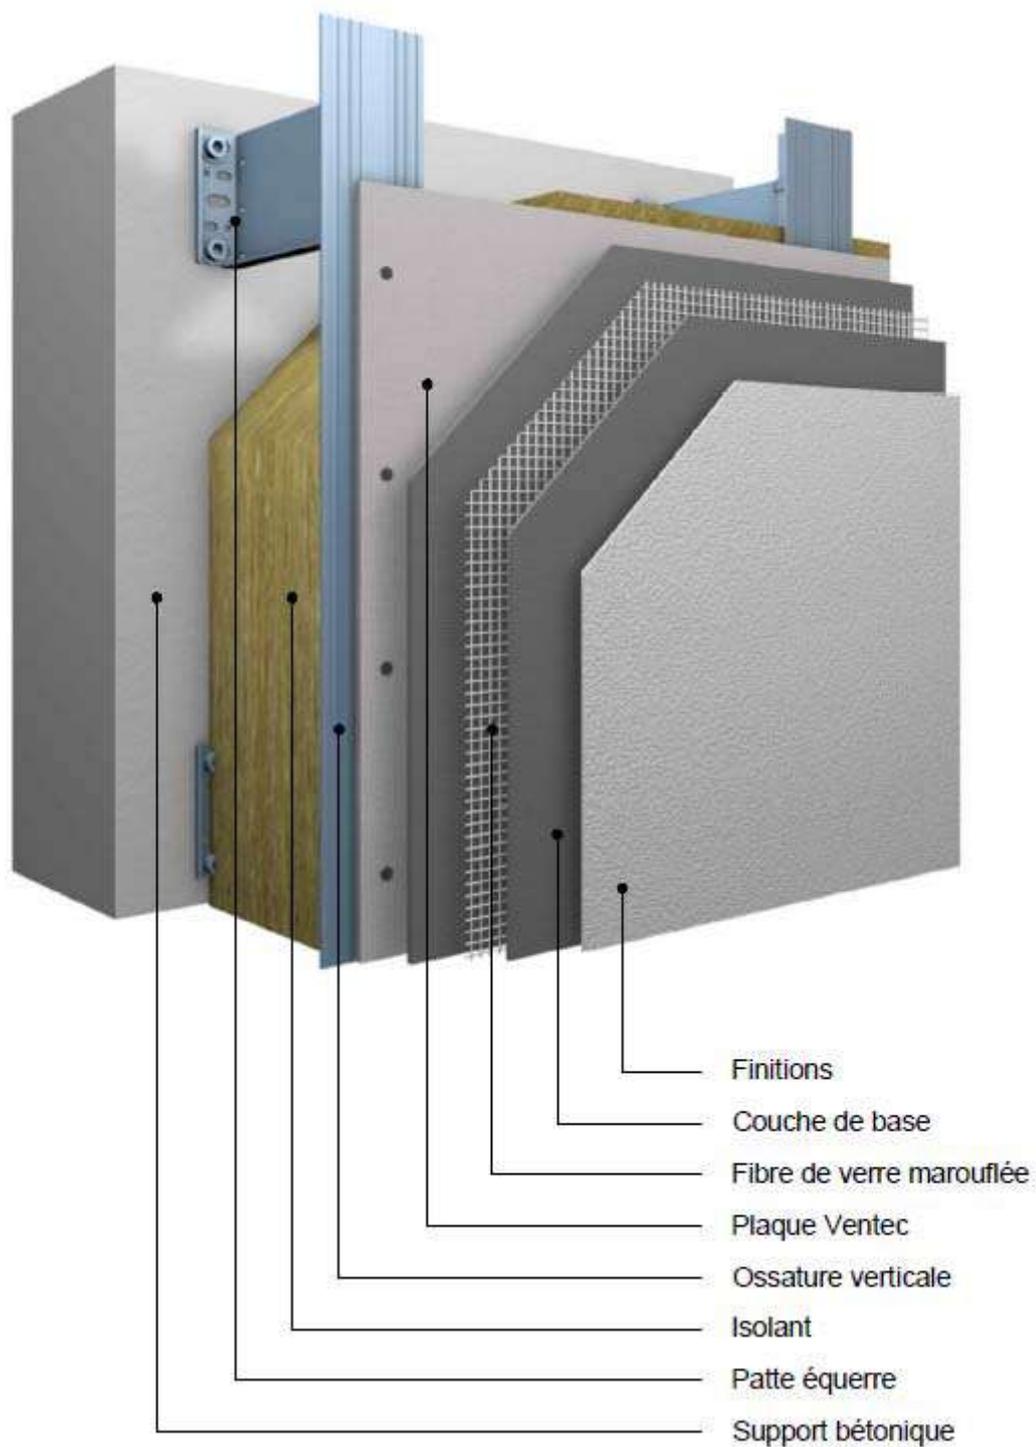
Composition d'un système StoVentec R Enduits sur béton ou maçonnerie
